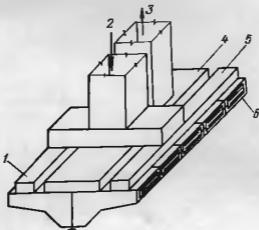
Предпочтительная схема присоединения воздуховодов к ПВЛУ при больших высотах помещений
